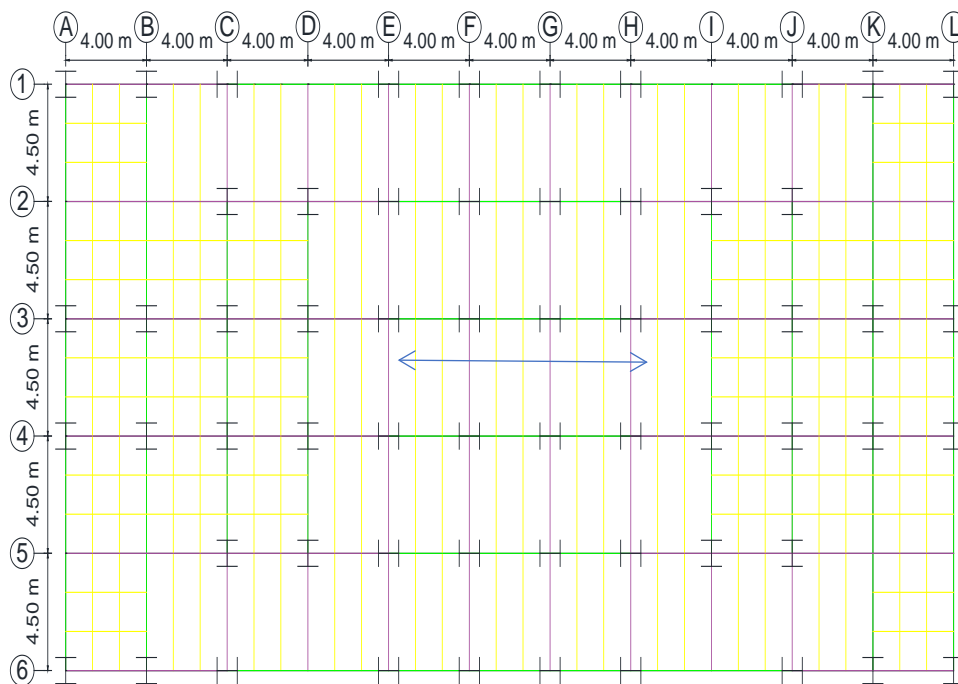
Planta de techo de la edificación con panel Vierendeel 1m.
